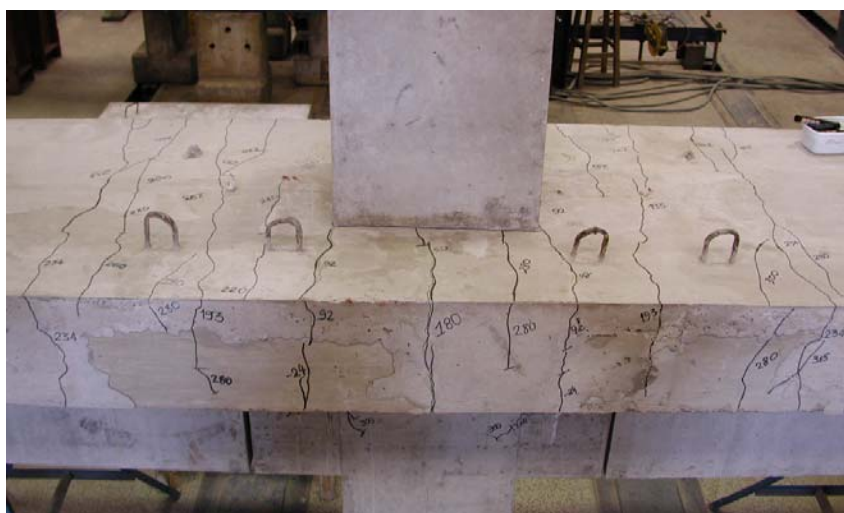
Configuração das fissuras na vista superior do modelo 2.1.
